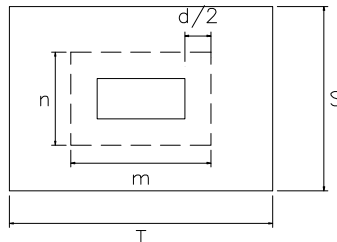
Vista en planta de área para punzonamiento por carga vertical.
